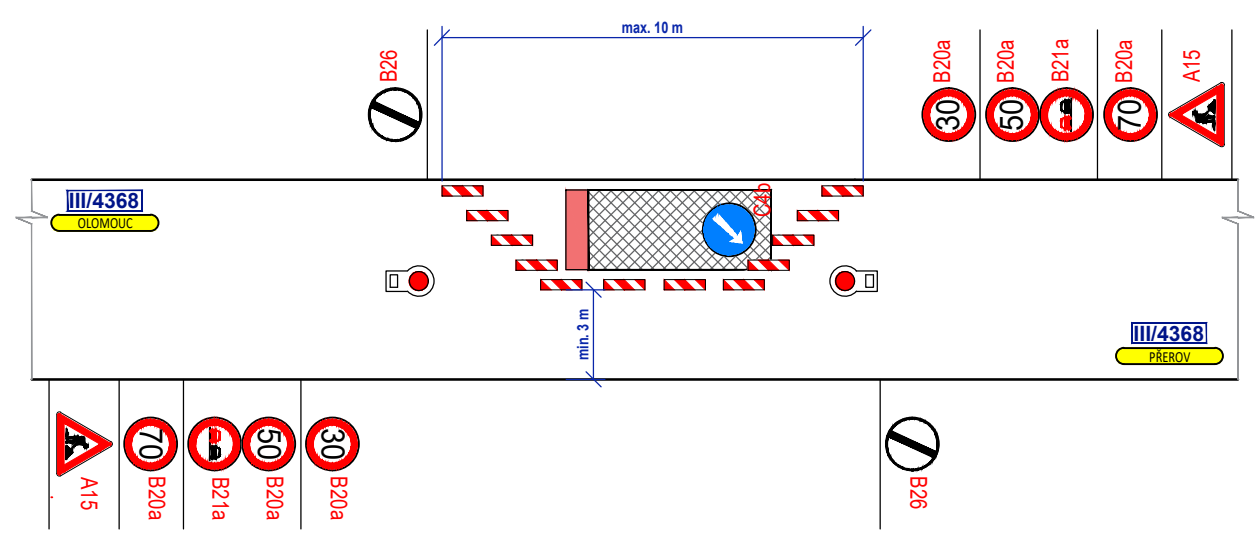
### DETAIL PRACOVNÍHO MÍSTA 5 - INTRAVILÁN
